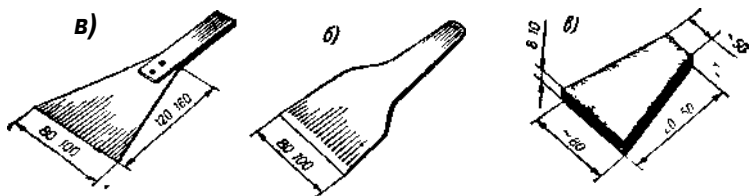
Шпатели: а—металлический; б — деревянный, в — резиновый
